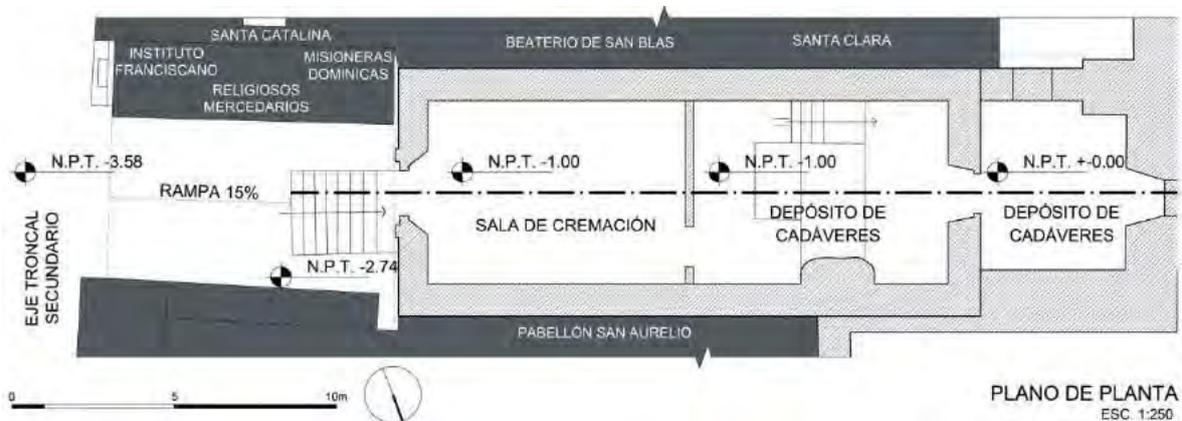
Plano de planta de la capilla Santo Roma del CRLAC.
